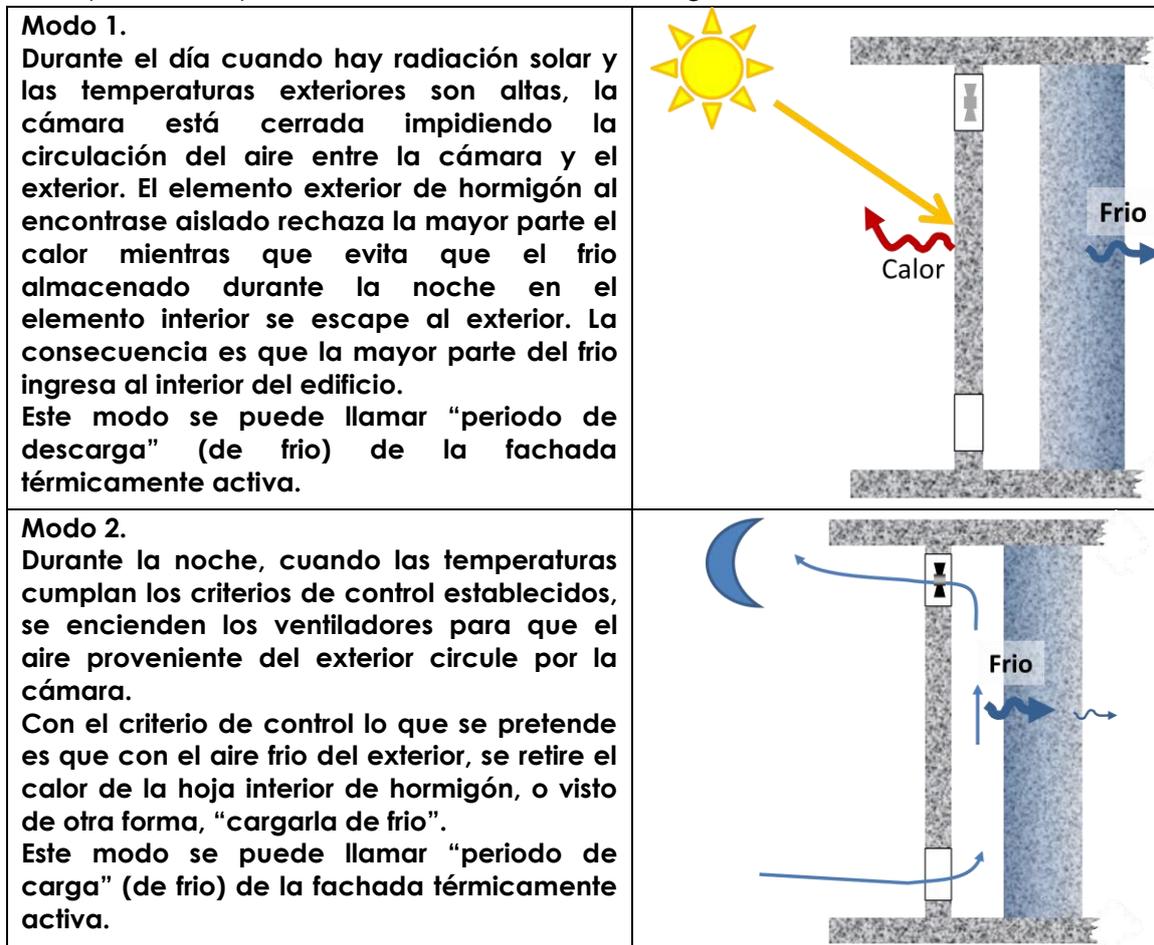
Elemento innovador de fachada en configuración de fachada térmicamente activa
